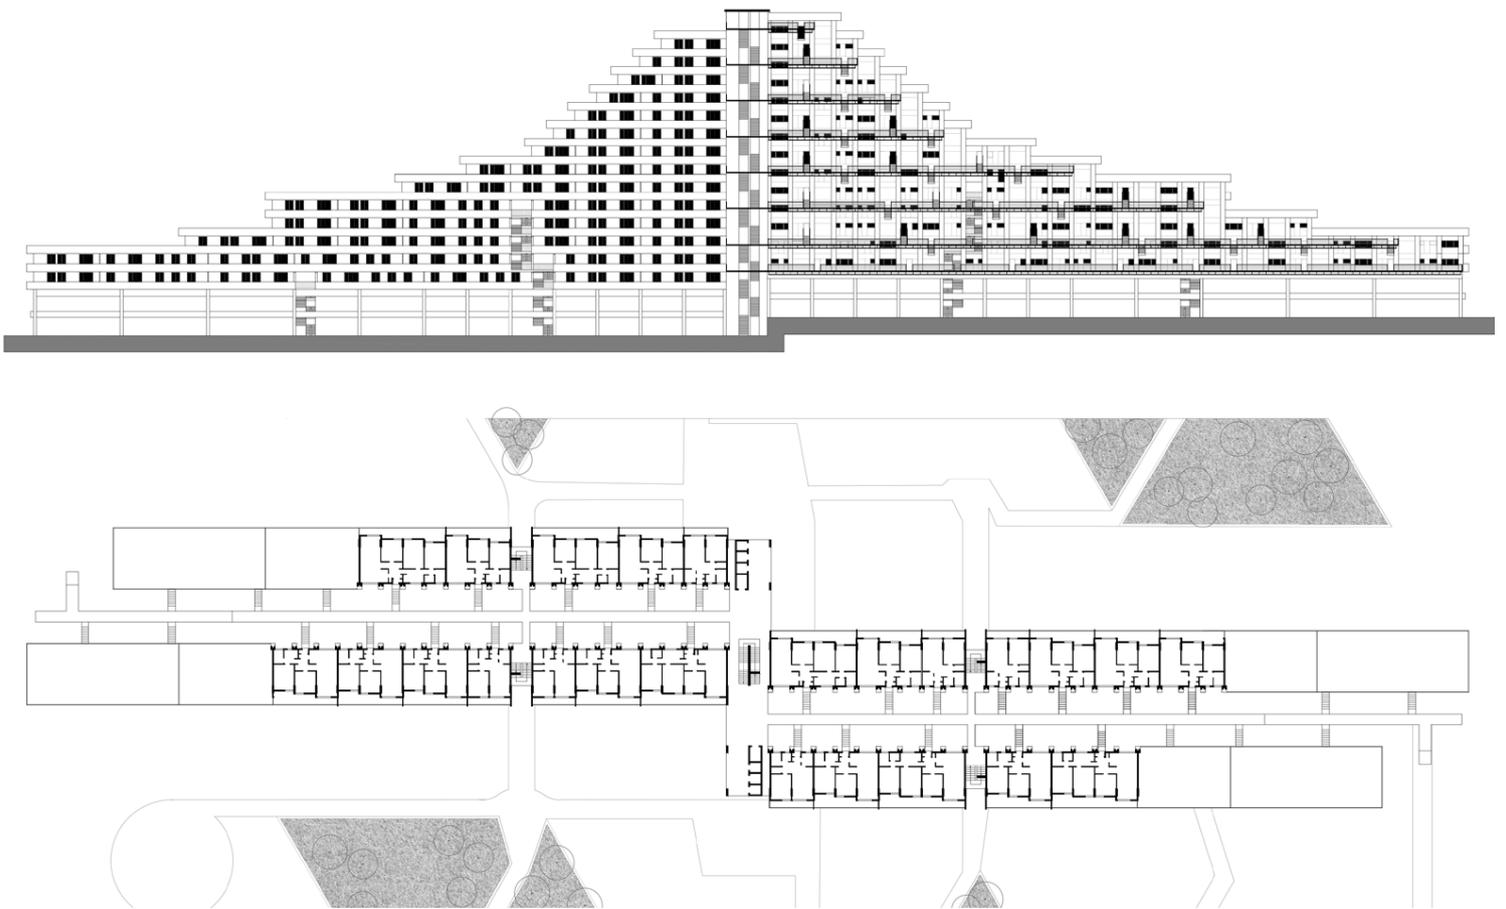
| Prospetto interno e pianta piano tipo progetto Vela B
